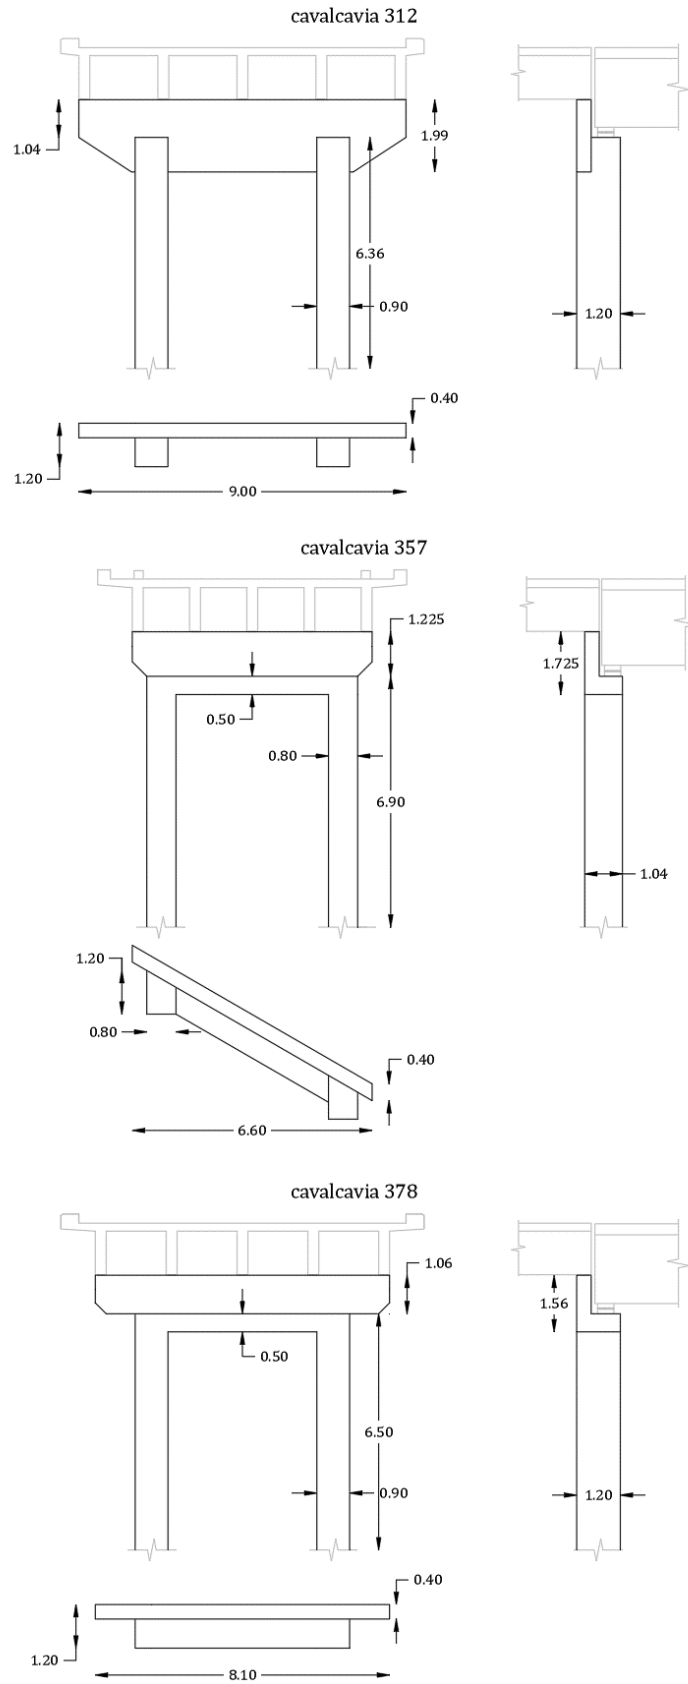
Sezione longitudinale e trasversale del sistema pila
